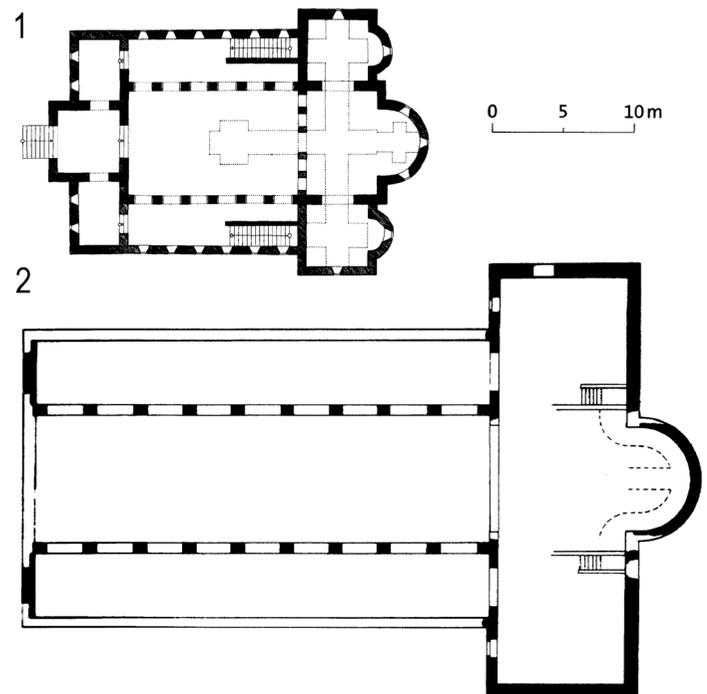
Grundrisse der Klosterkirchen in Steinbach und Seligenstadt, beide Klostergründungen Einhards.
